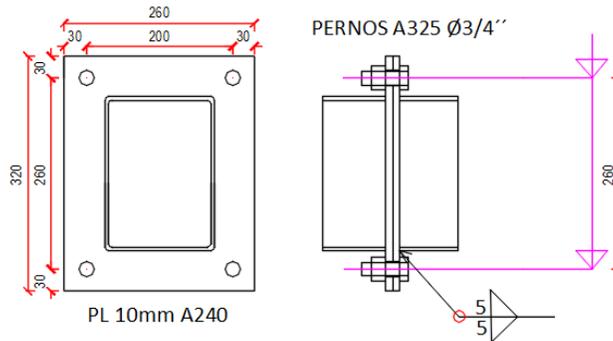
Unión del sistema Metalcon con el perfil canal.
